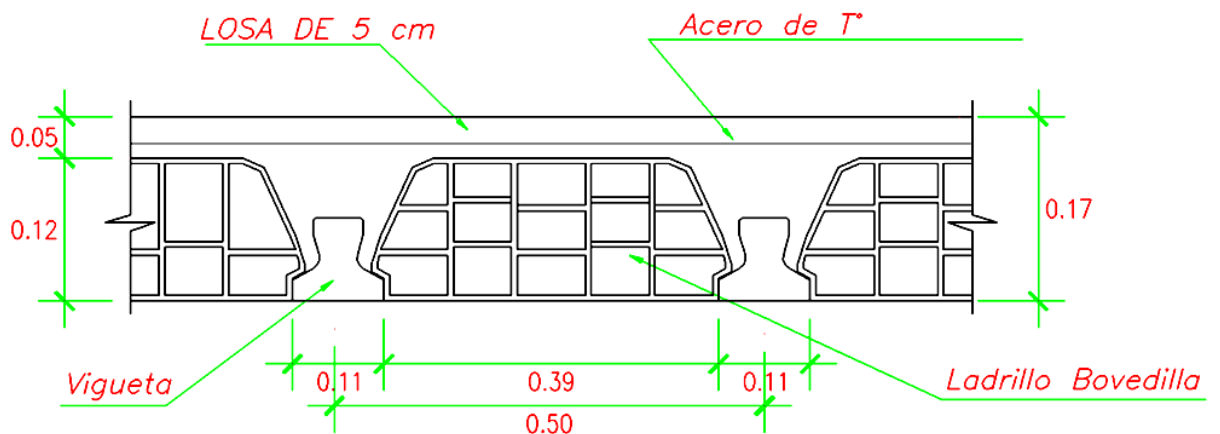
a: Sección de Losa Aligerada con Viguetas Firth
